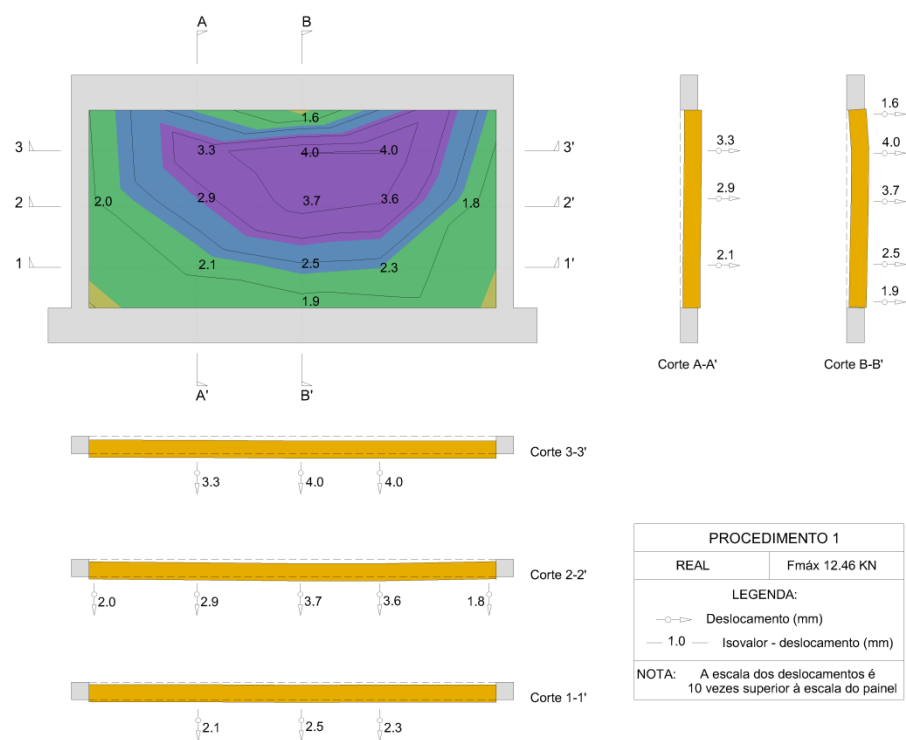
Isovalores da parede ensaiada - Procedimento 1. Ensaio fora do plano, Wall_REF_02.
